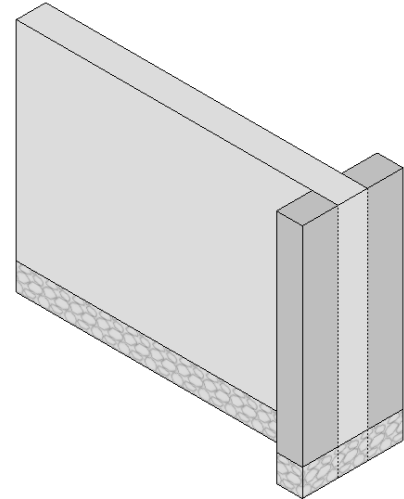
La tipología de los especímenes para construir el contrafuerte, dependerán del sistema constructivo a confinar. Fuente: Elaboración propia.
